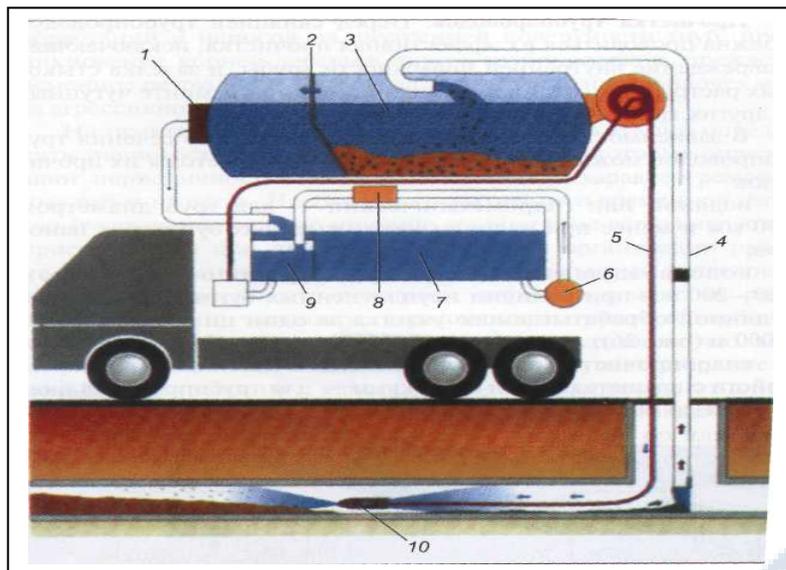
Схема гидропрочистки трубопровода от отложений и отложений и ржавчины
